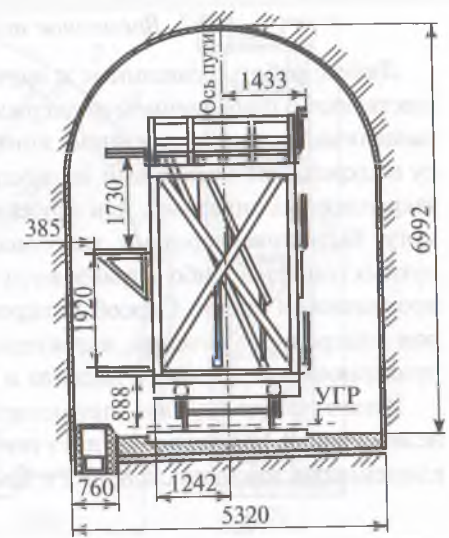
Подмости с откидными площадками для работ в однопутных тоннелях, смонтированные на железнодорожной платформе
